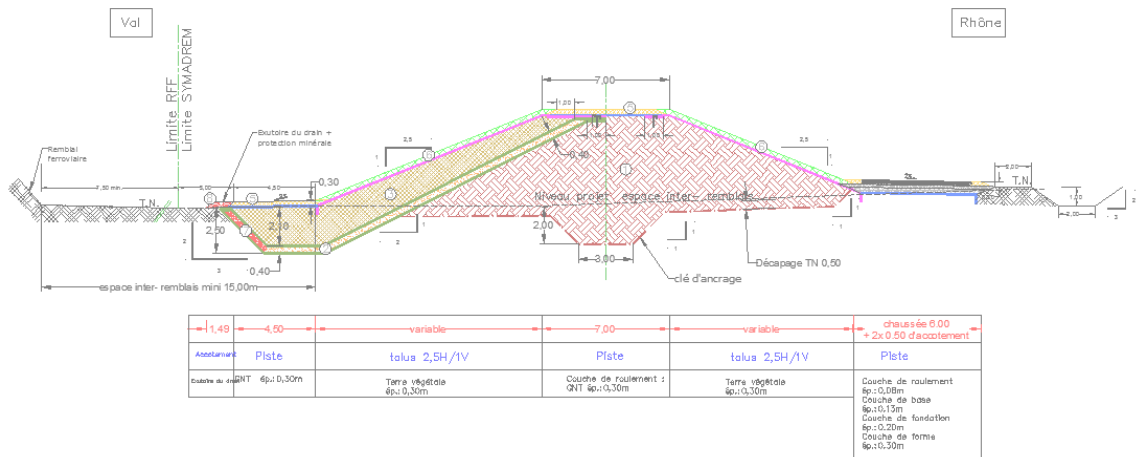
Coupe type d'une digue de protection en bordure du Rhône (source : Safège, 2014)
